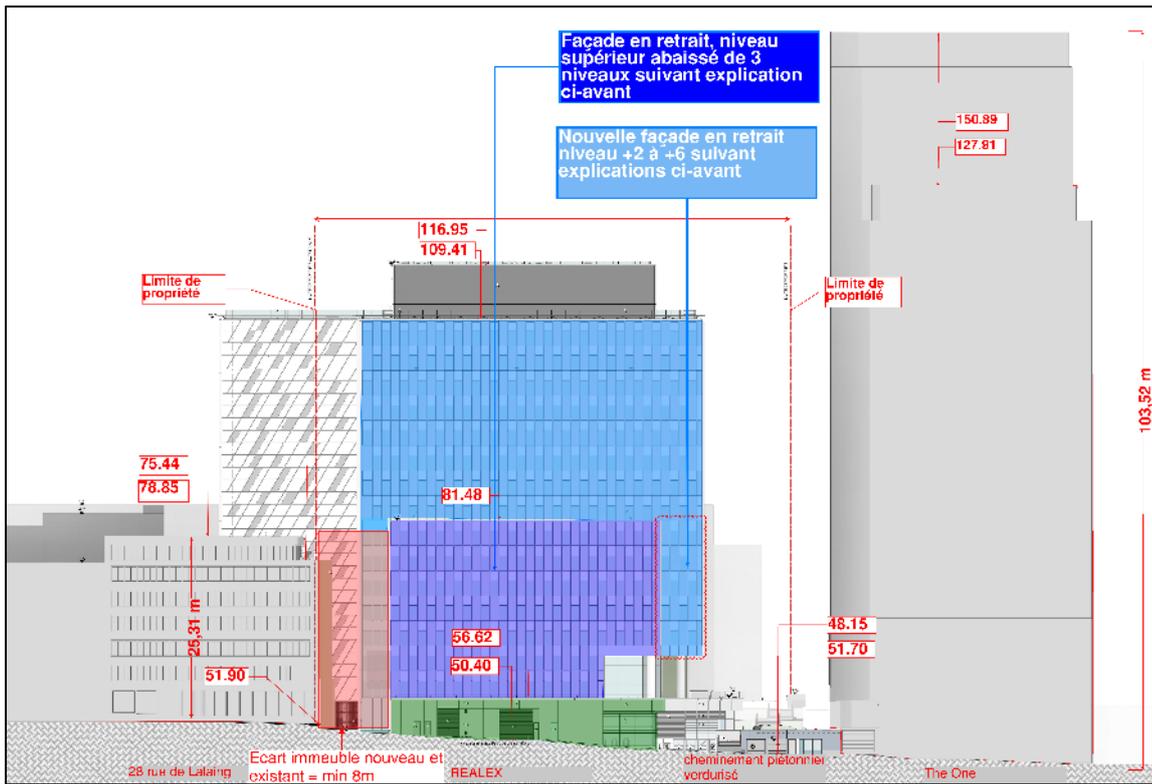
b : Hauteurs des gabarits Rue Lalaing – Projet modifié
